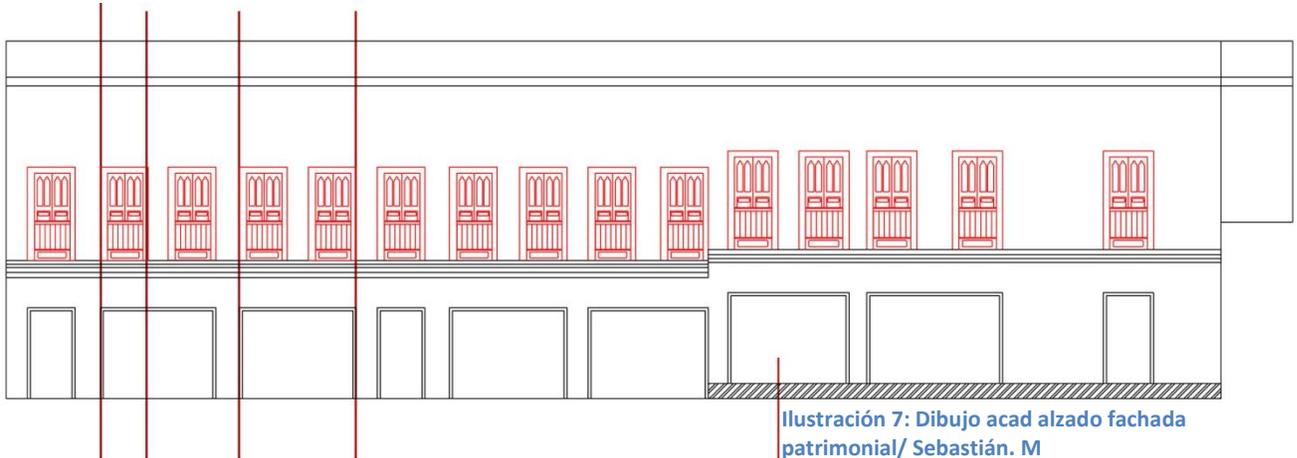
Dibujo acad alzado fachada patrimonial/ Sebastián. M
